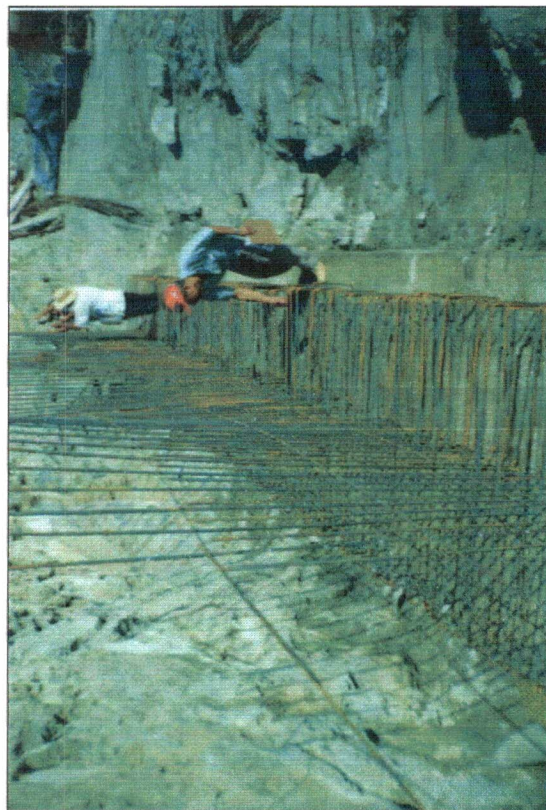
Colocação da ferragem para arrumação final.
